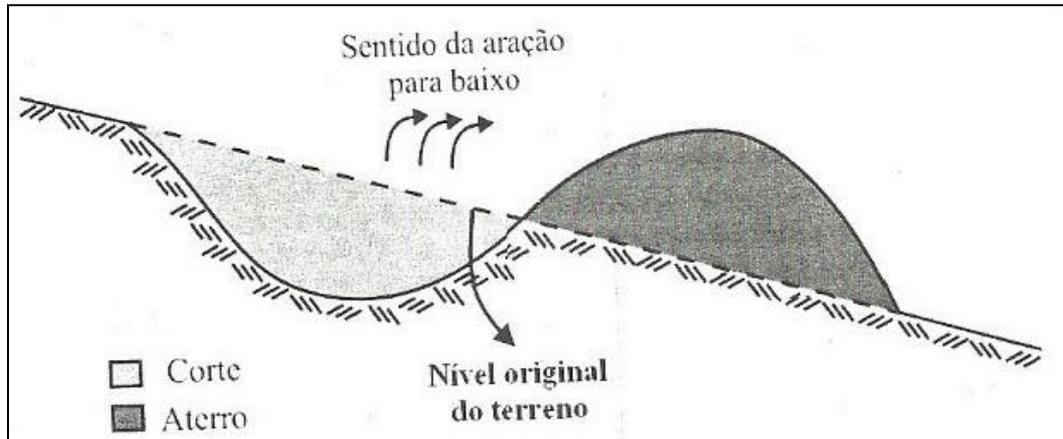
Perfil esquemático de um terraço tipo Nichol's
